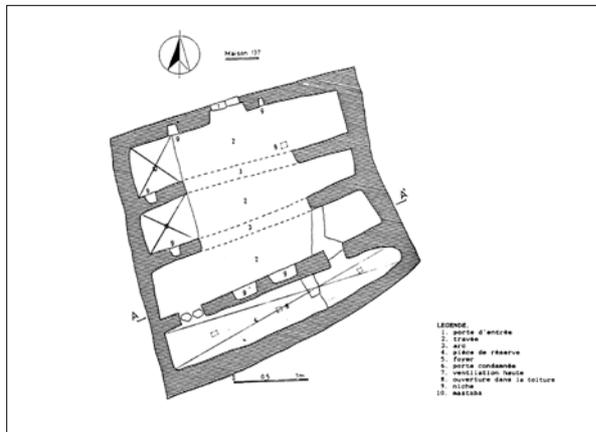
'Aima/Jordanien - Gebäude 137, x – Speicher-Raum mit Dachöffnungen (4) (Biewers 1987:pl.2)
